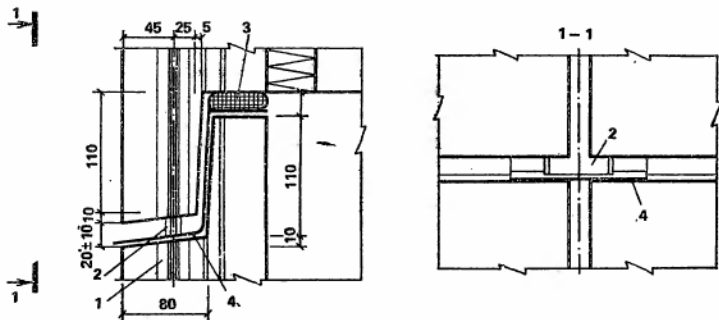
Схема герметизации устья горизонтального открытого стыка
